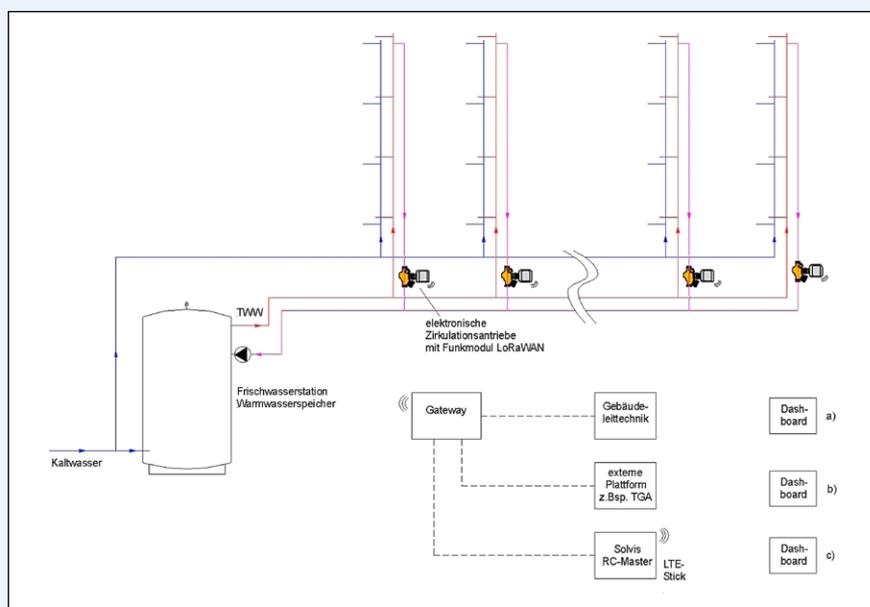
Strangenschema einer zentralen Trinkwasserinstallation mit elektronischen Zirkulationsantrieben
